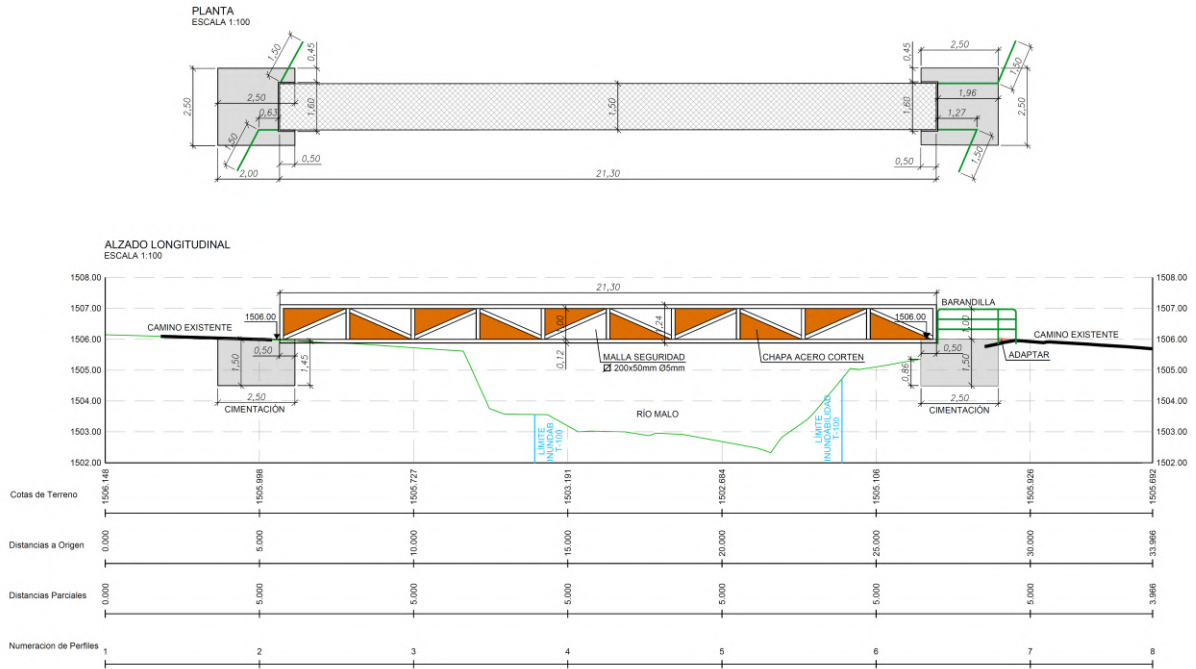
Planta y alzado longitudinal de las pasarelas.
